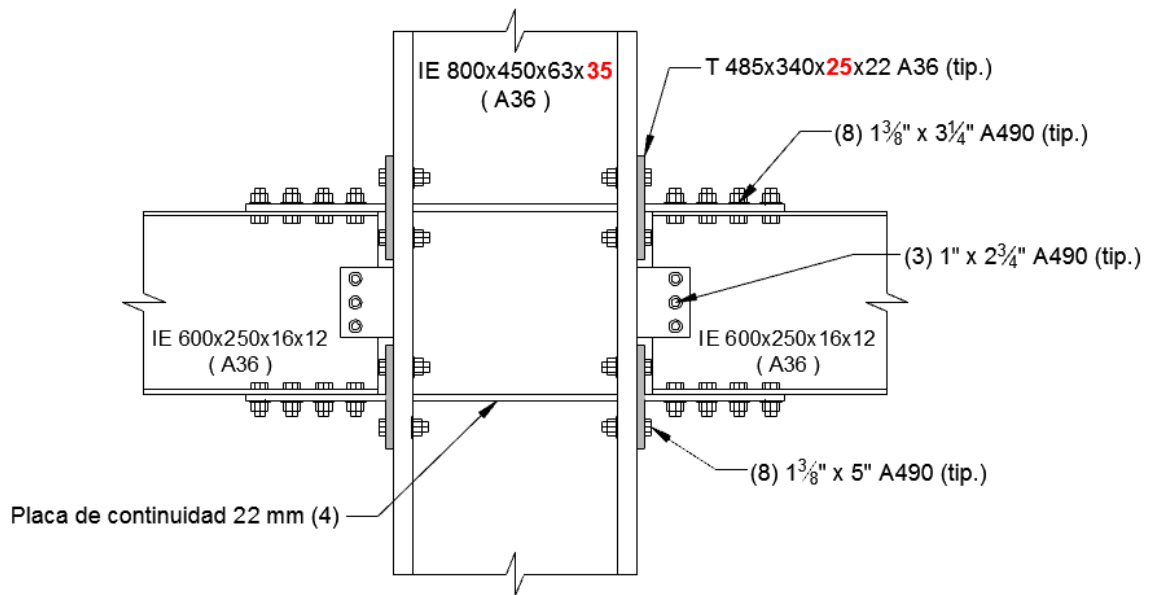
Detalle de conexión SE-01 (DBT2). Fuente: Salas (2016)
